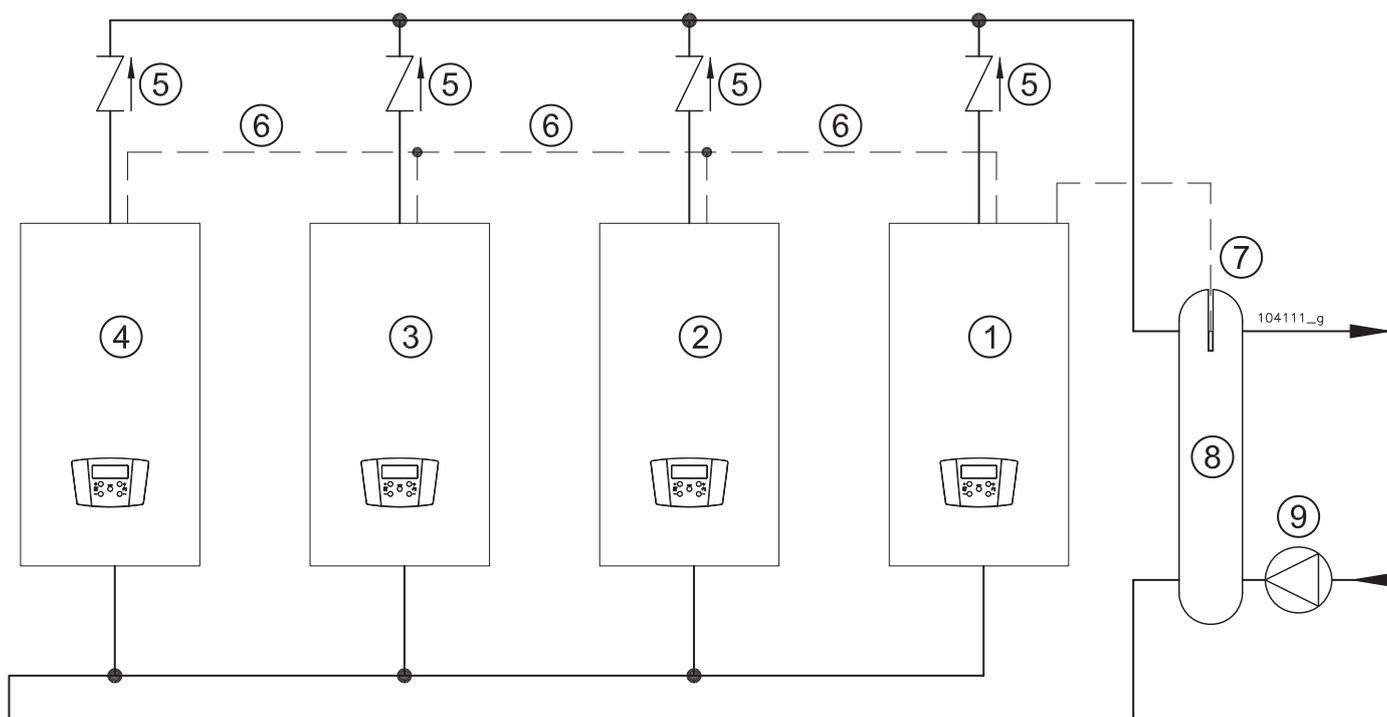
Schema concettuale di collegamento apparecchi in cascata
